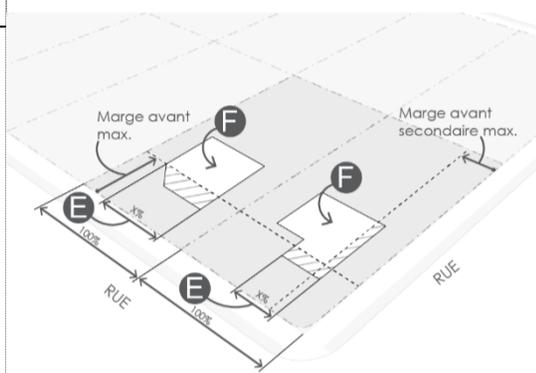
Front bâti et superficie d'implantation au sol d'un bâtiment
